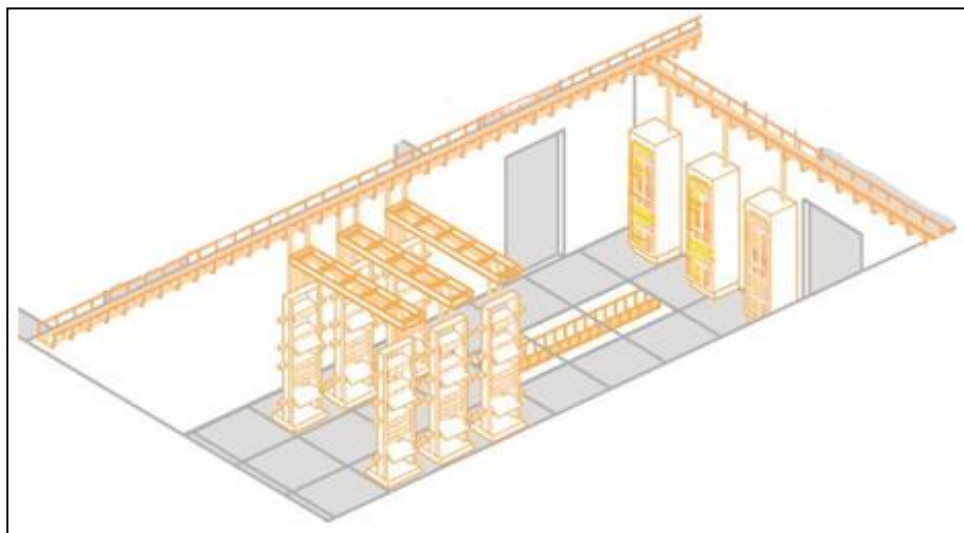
Exemplo de *Layout* de Sala Técnica Primária.
